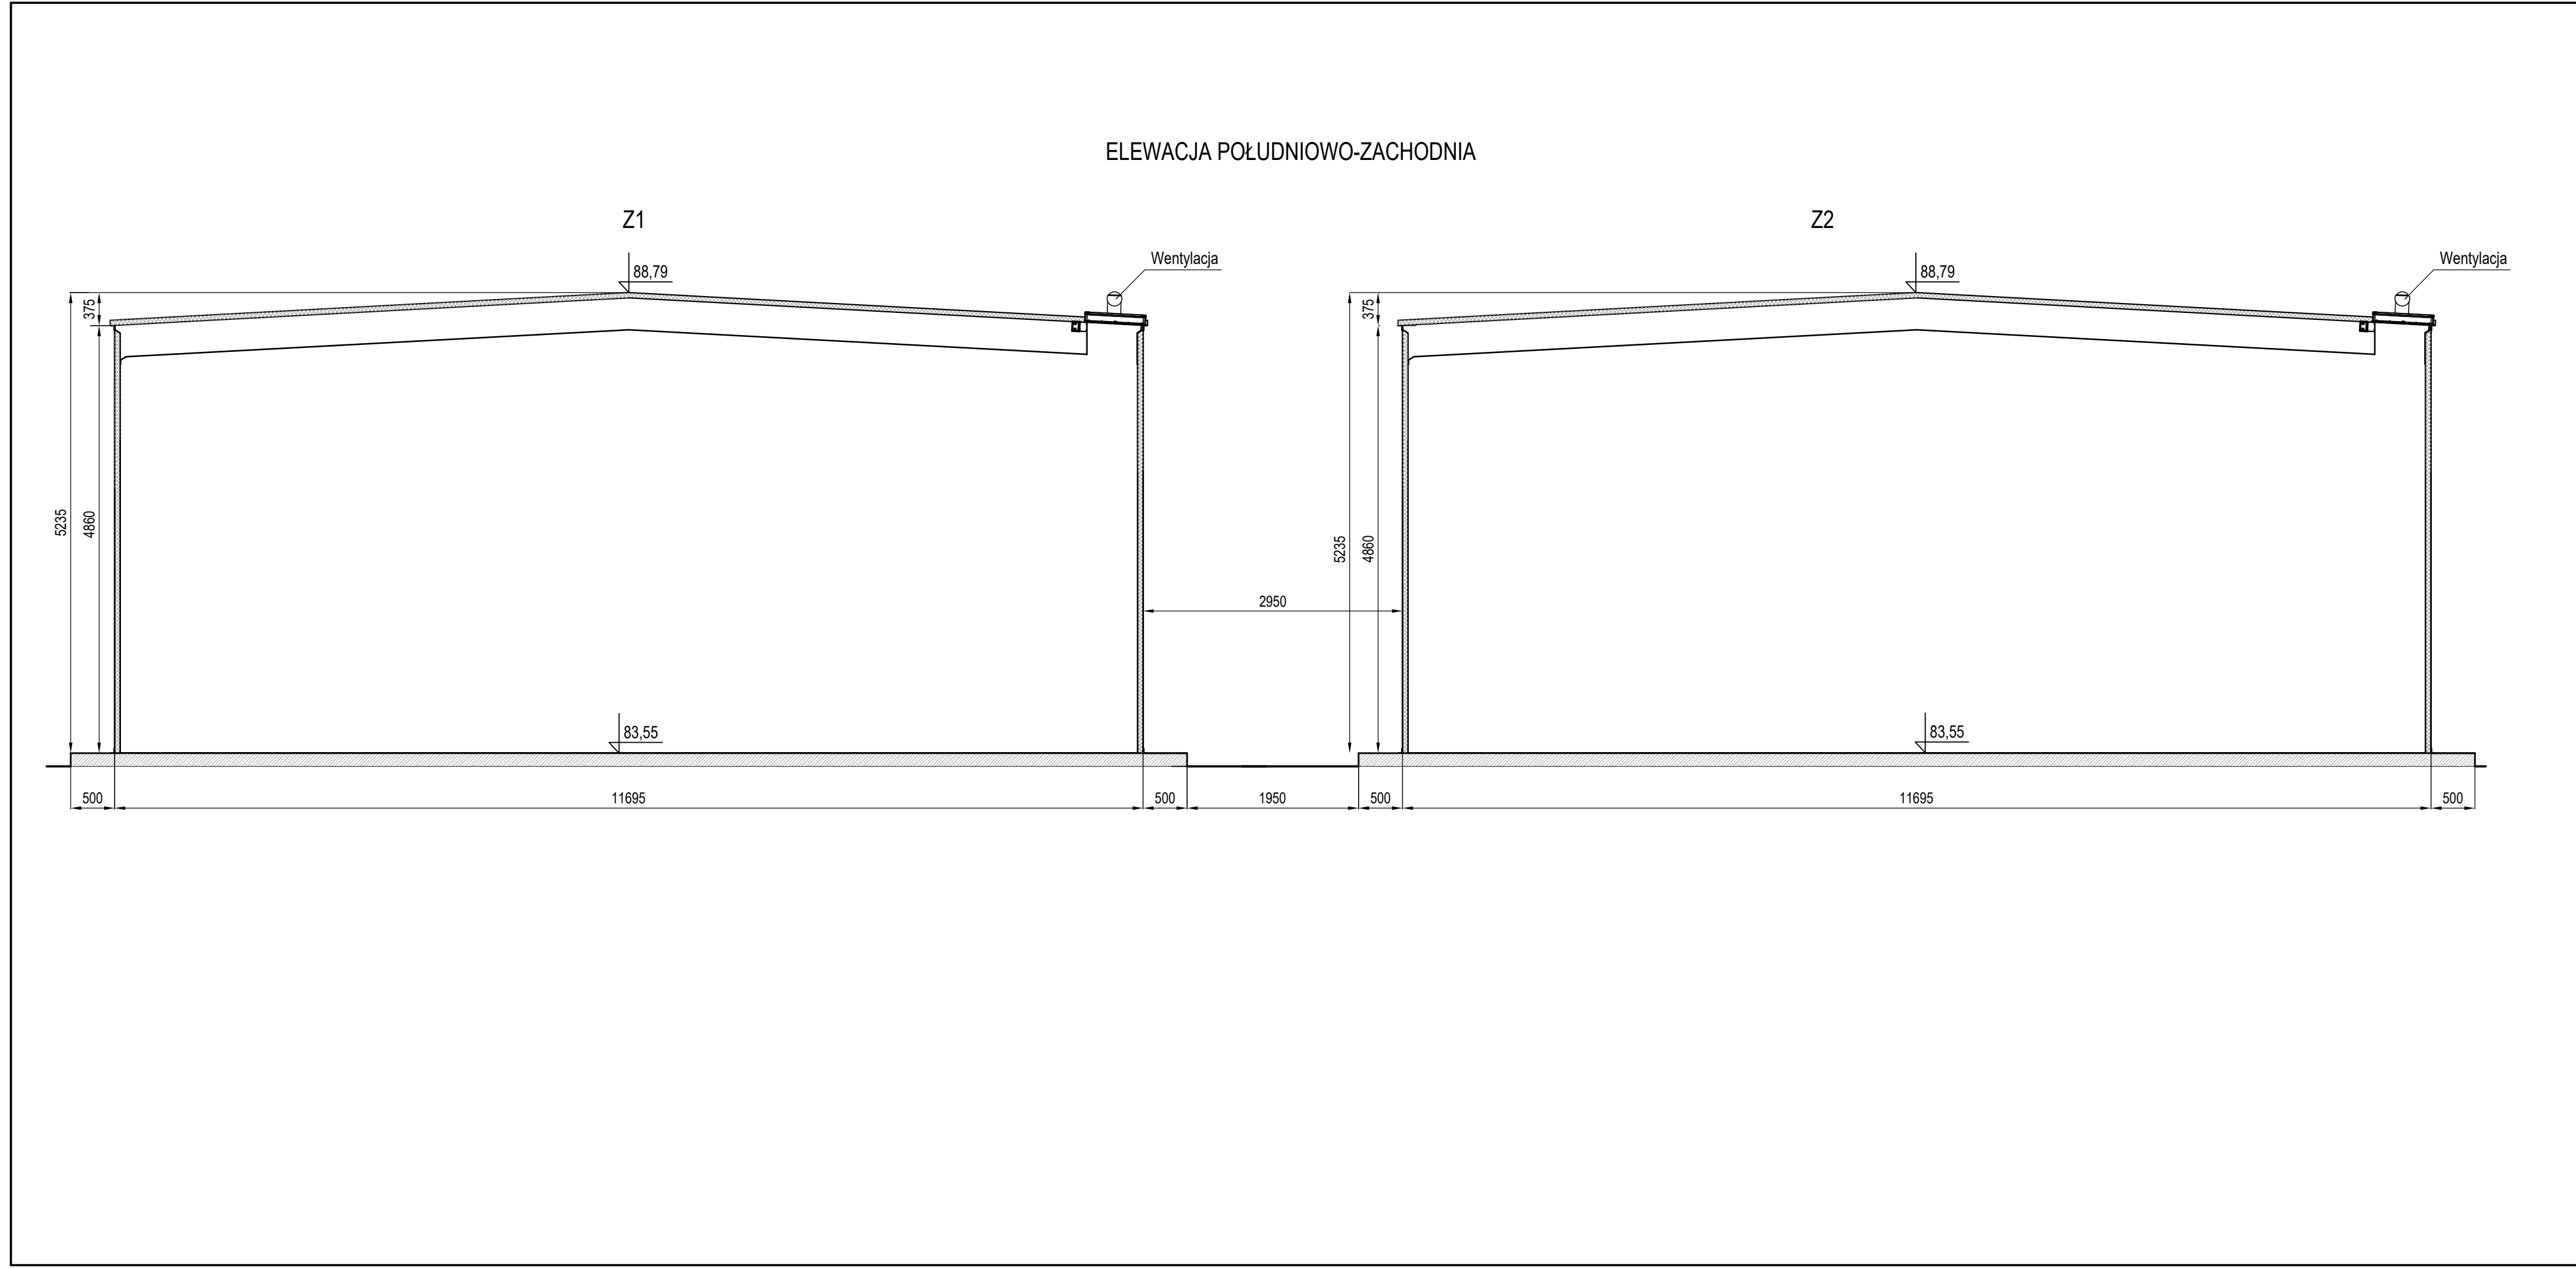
Elewacja projektowanych zbiorników – str. nr 69
